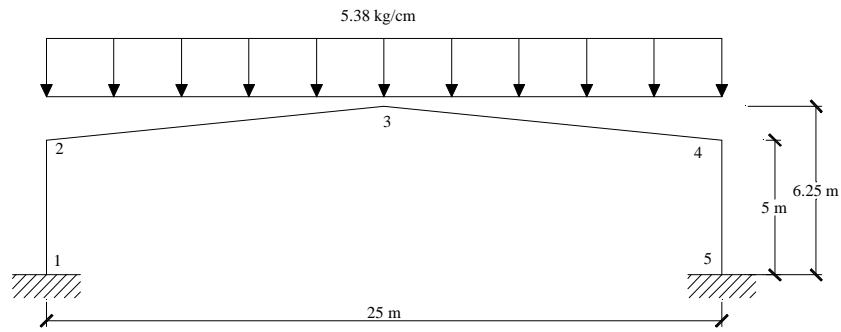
Cargas aplicadas sobre las barras en el pórtico ejemplo.
